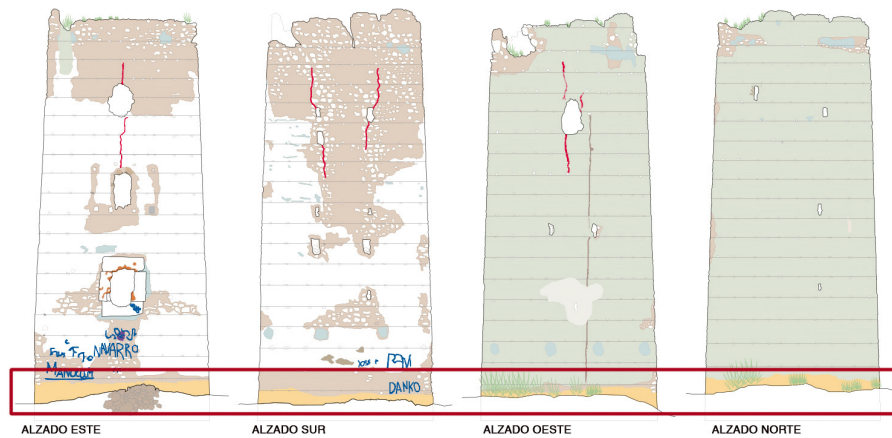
8.35. Vista de la cimentación en el alzado Norte y Oeste.
